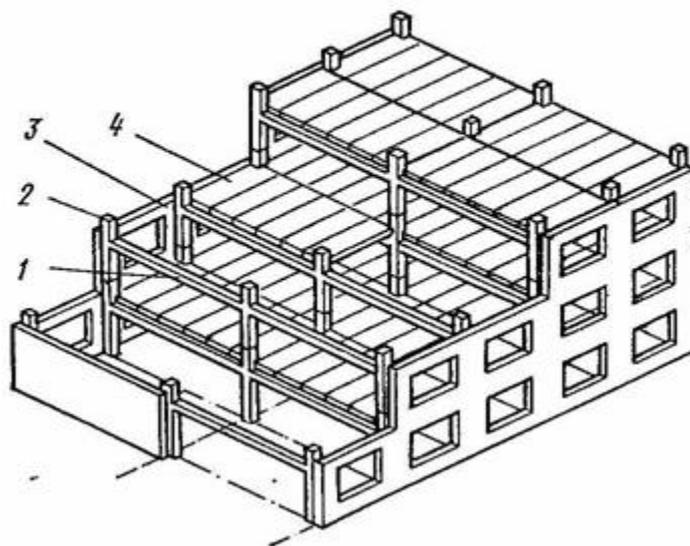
Схема цивільних будівель з повним каркасом; 1 – ригель; 2 – колонна; 3 – само несуча стіна; 4 – перекриття;
